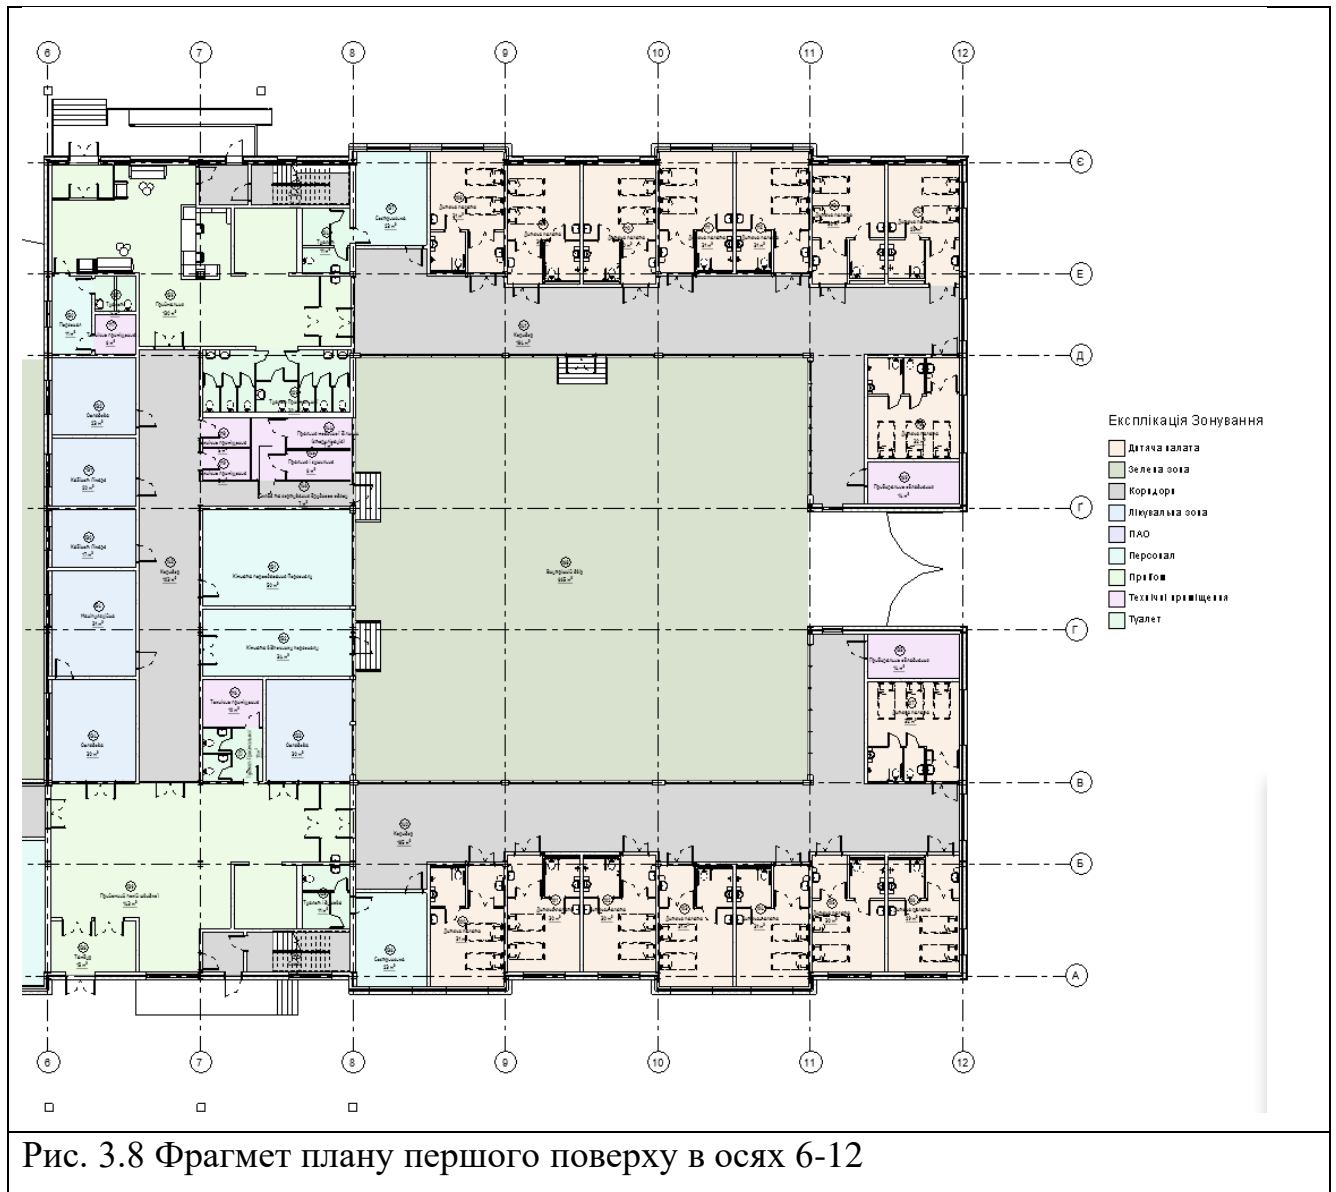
Фрагмент плану першого поверху в осях 6-12
